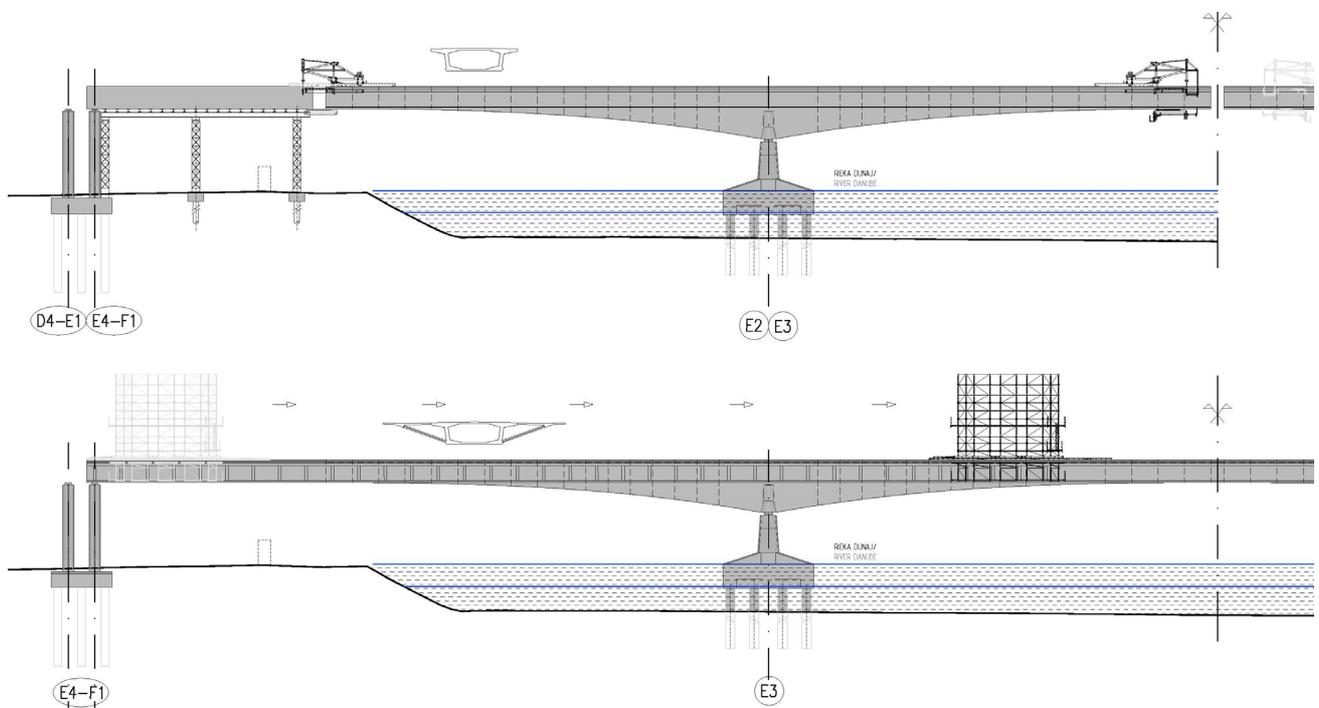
Detalle de las distintas fases del proceso constructivo: construcción del cajón central en las inmediaciones de pila mediante carro de avance en voladizo, y en las inmediaciones de estribo mediante cimbra convencional apoyada en el terreno. Construcción de los voladizos mediante carro de alas en segunda fase.
